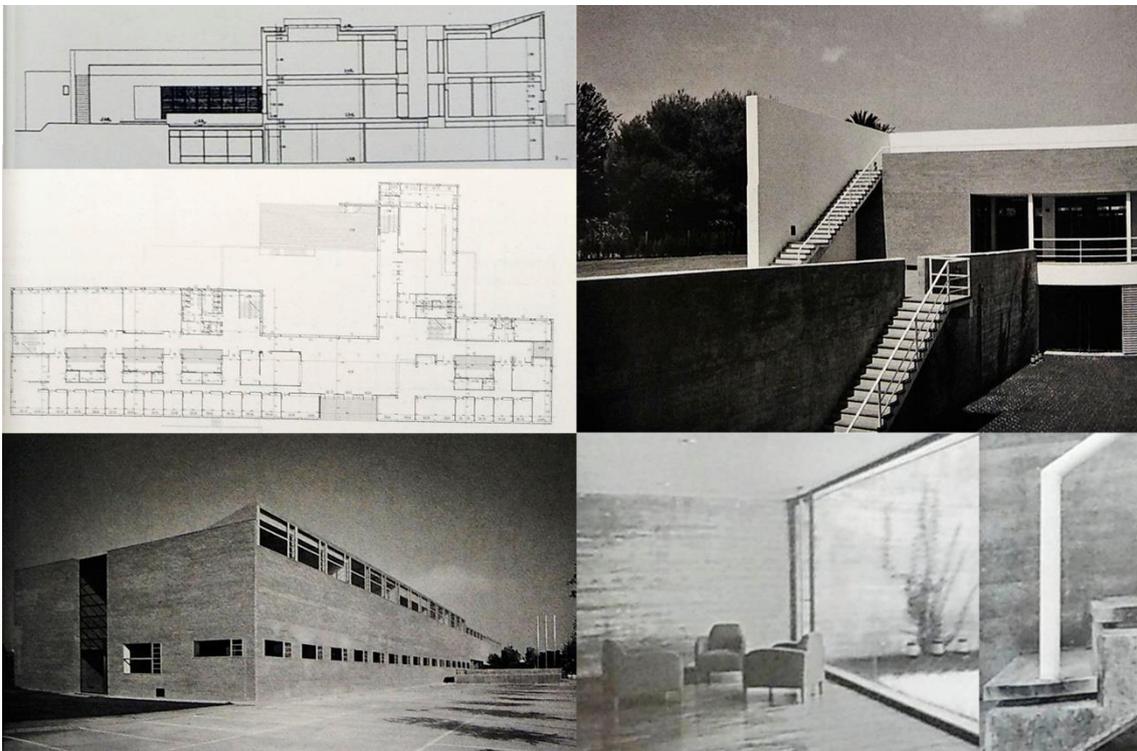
Planta y sección, vistas exteriores, vista interior y detalle escalera.
